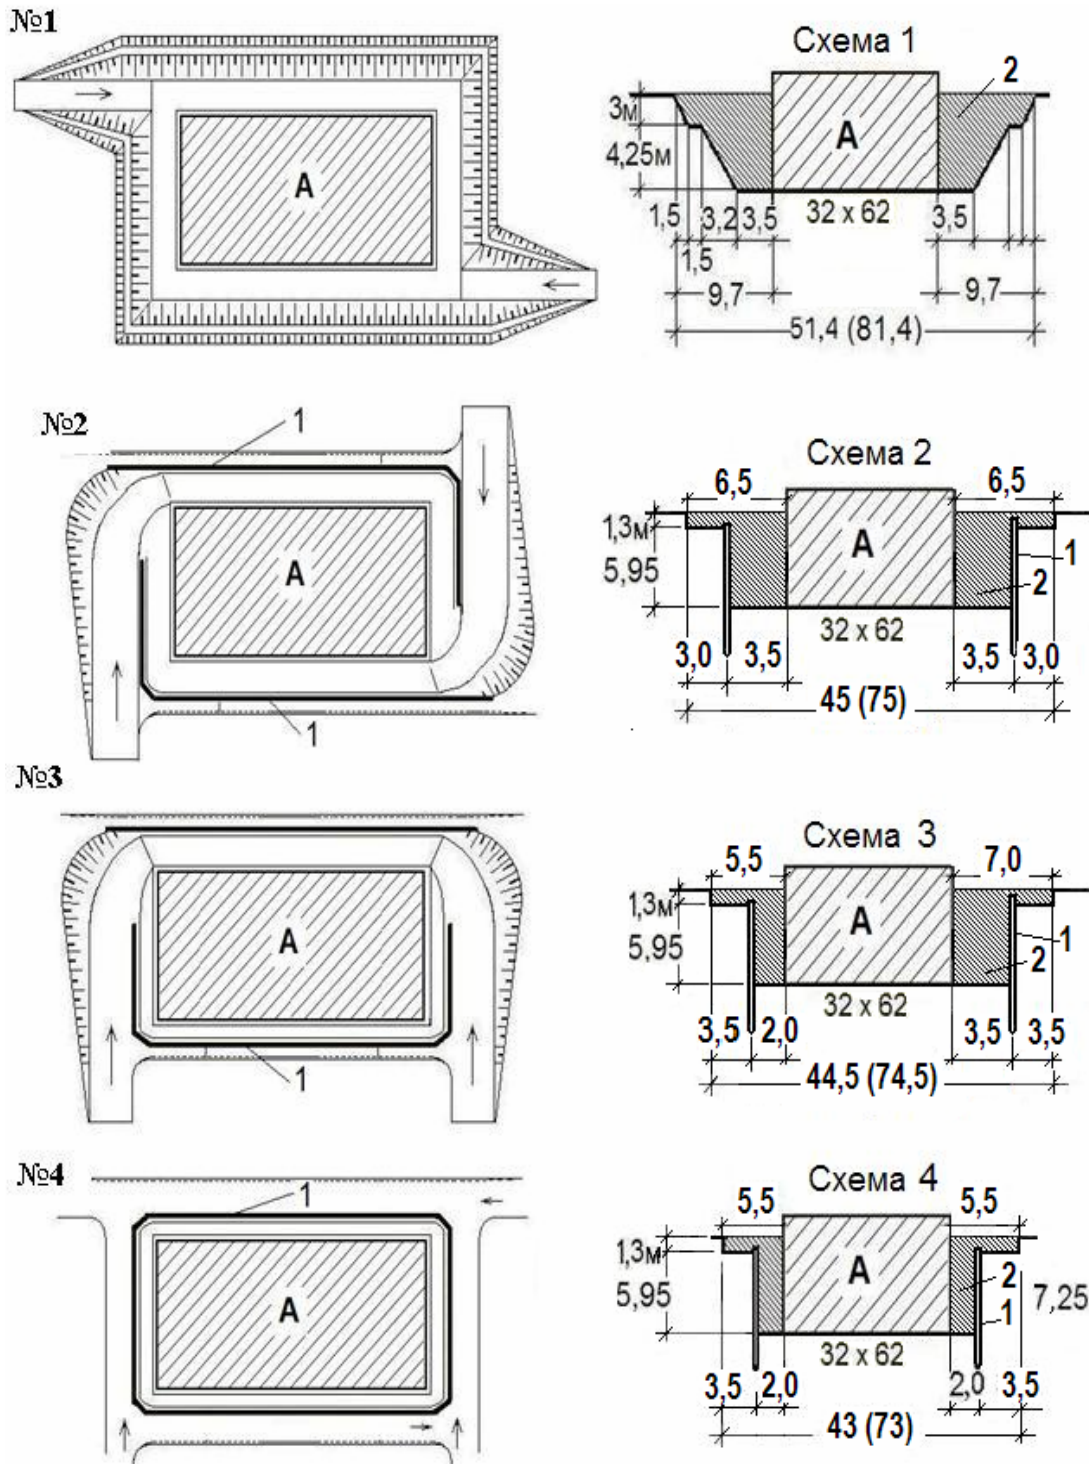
Варианты планов и схемы поперечных сечений котлованов: А – строящееся здание; 1 – шпунтовое ограждение; 2 – обратная засыпка.
